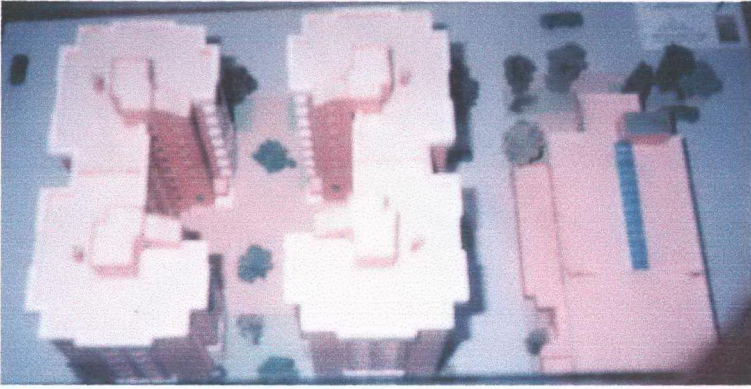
Barışkent II toplu konut alanı vaziyet plan
